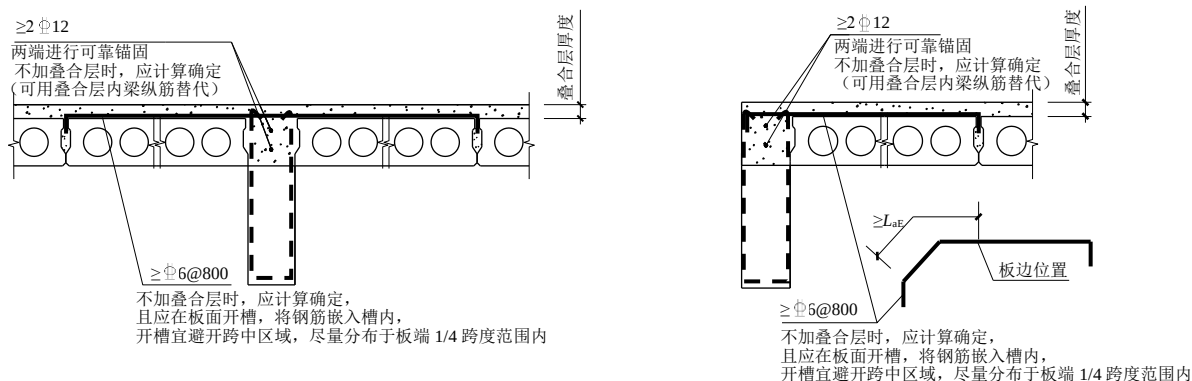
板侧与钢筋混凝土梁连接节点
